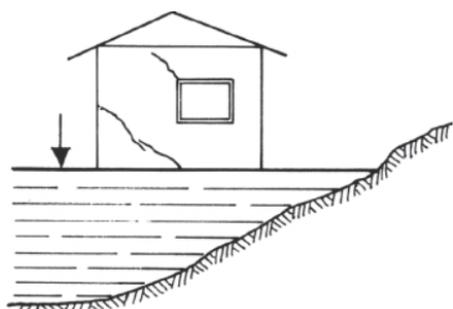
Fissuras decorrentes de recalque diferencial em edificação atingida
